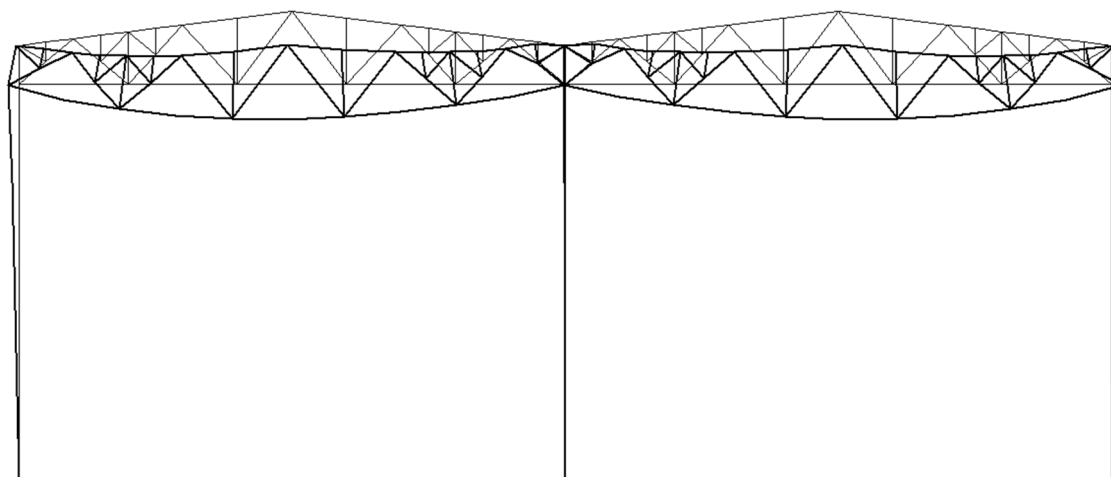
Схема деформирования поперечной рамы каркаса СКЦ при действии вертикальной нагрузки
